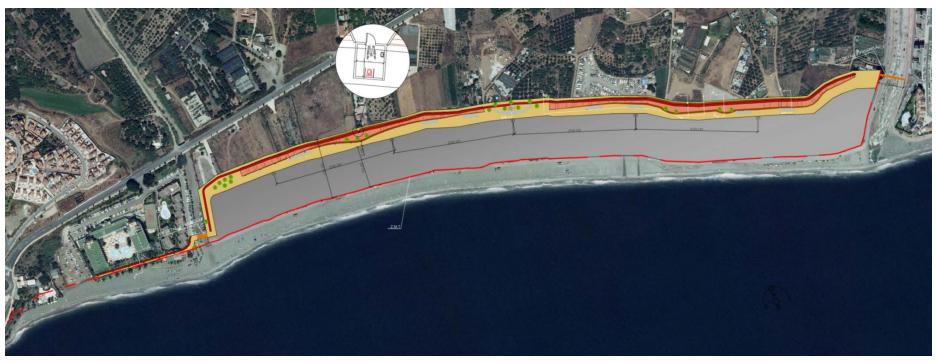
Planta General del Paseo Marítimo de El Playazo proyectado en la Alternativa 1.
